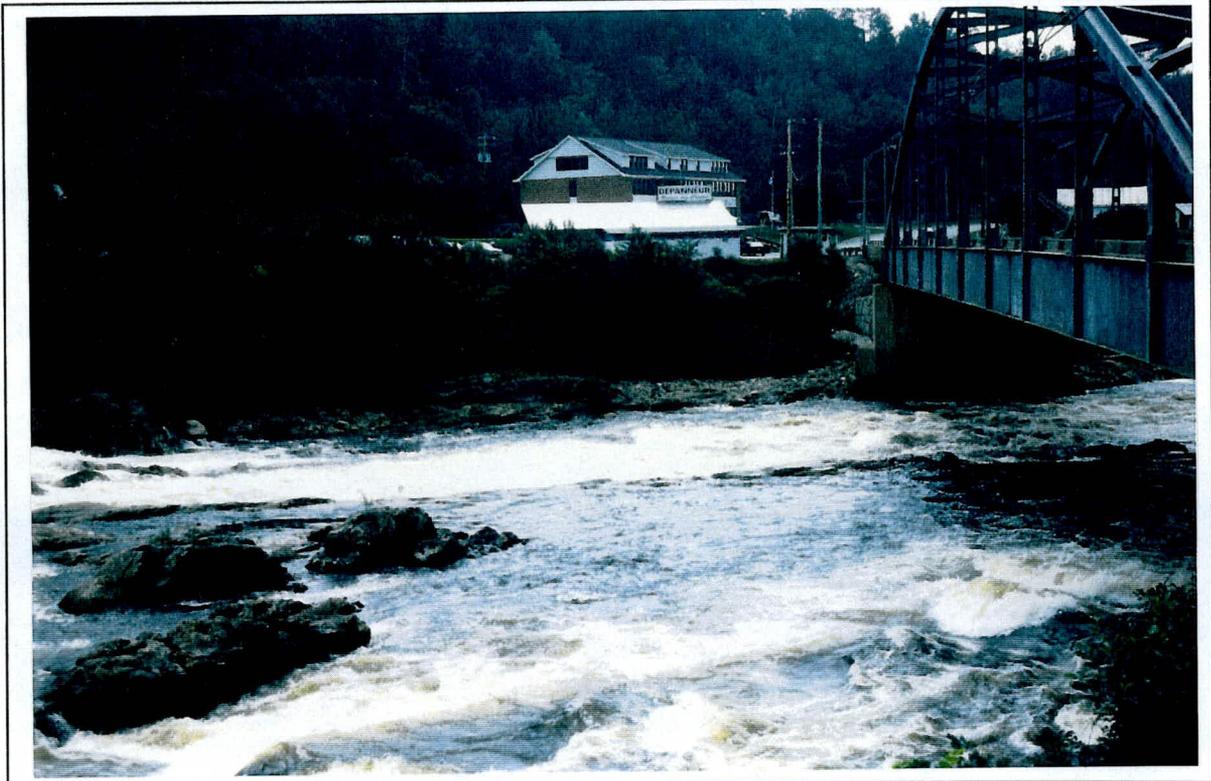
Projet 6674-9504-B, route 117, secteur 2, portion nord-est.(SSE)
